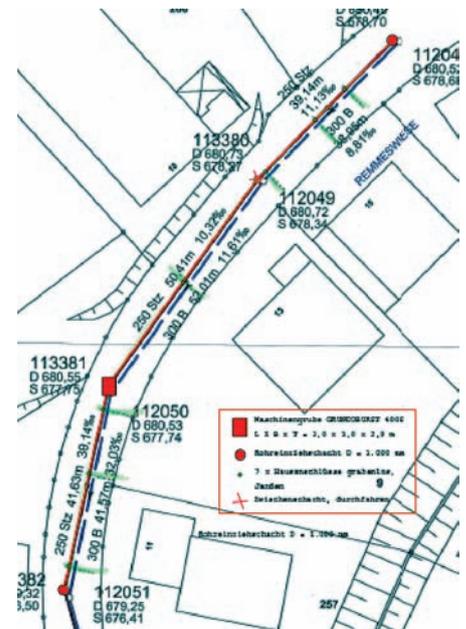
Lageplan der zwei zu sanierenden Hal-tungen in Winterberg
